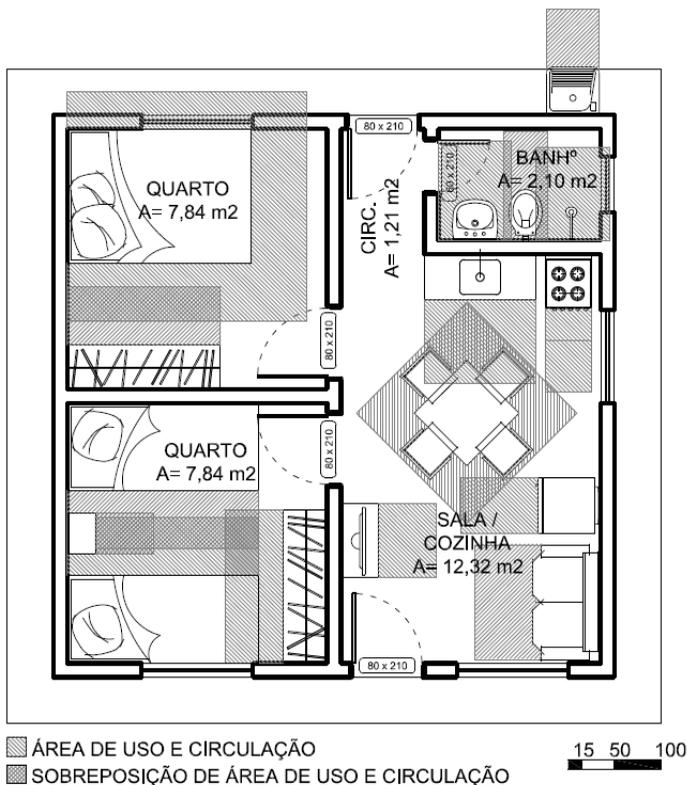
Projeto UH tipo 1, Conjunto 1 – planta original
